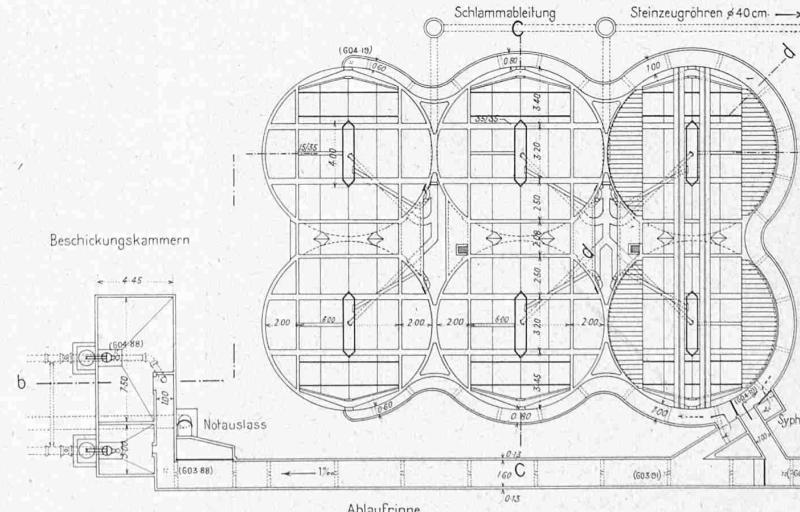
Grundriss der Vor-Reinigungs-Anlage (Emscherbrunnen). — Maßstab 1:400.
